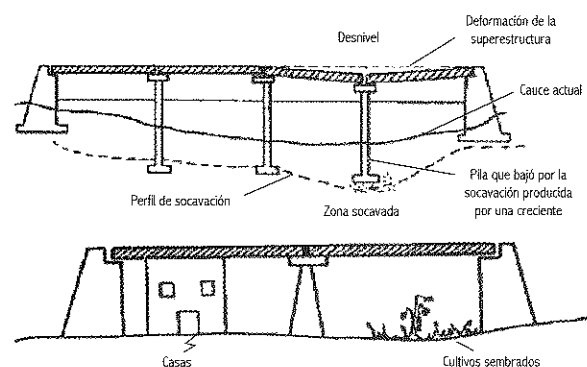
(a) Asentamiento por socavación en pilas (b) Obstrucción del cauce.
